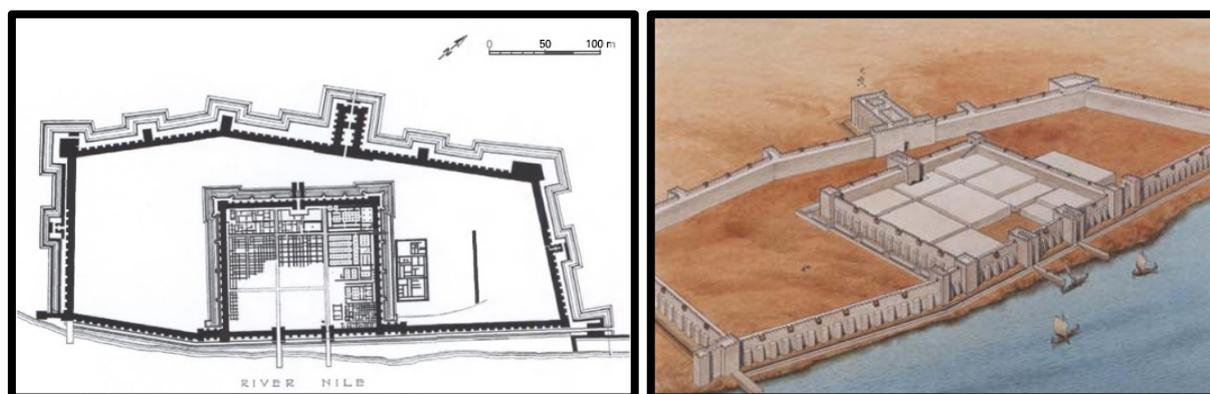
Vue en plan et en élévation de la Forteresse de Buhen sur le Nil
